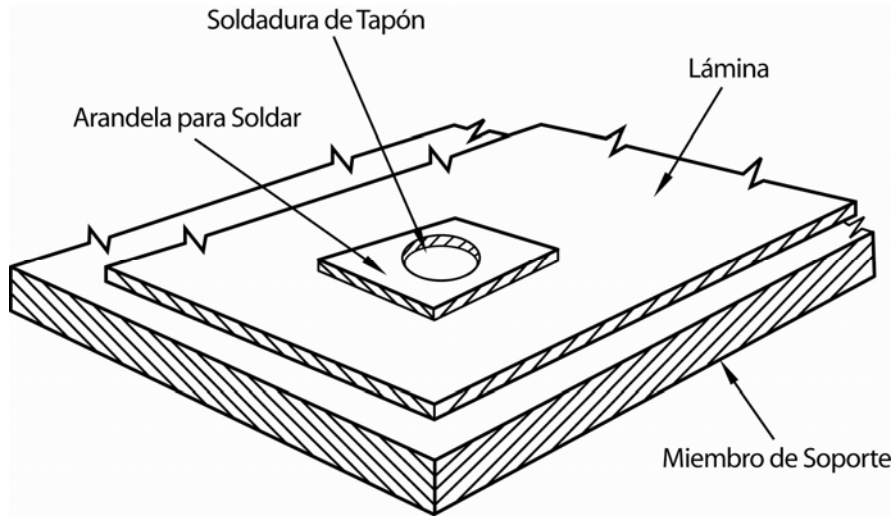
Arandela para soldadura típica
